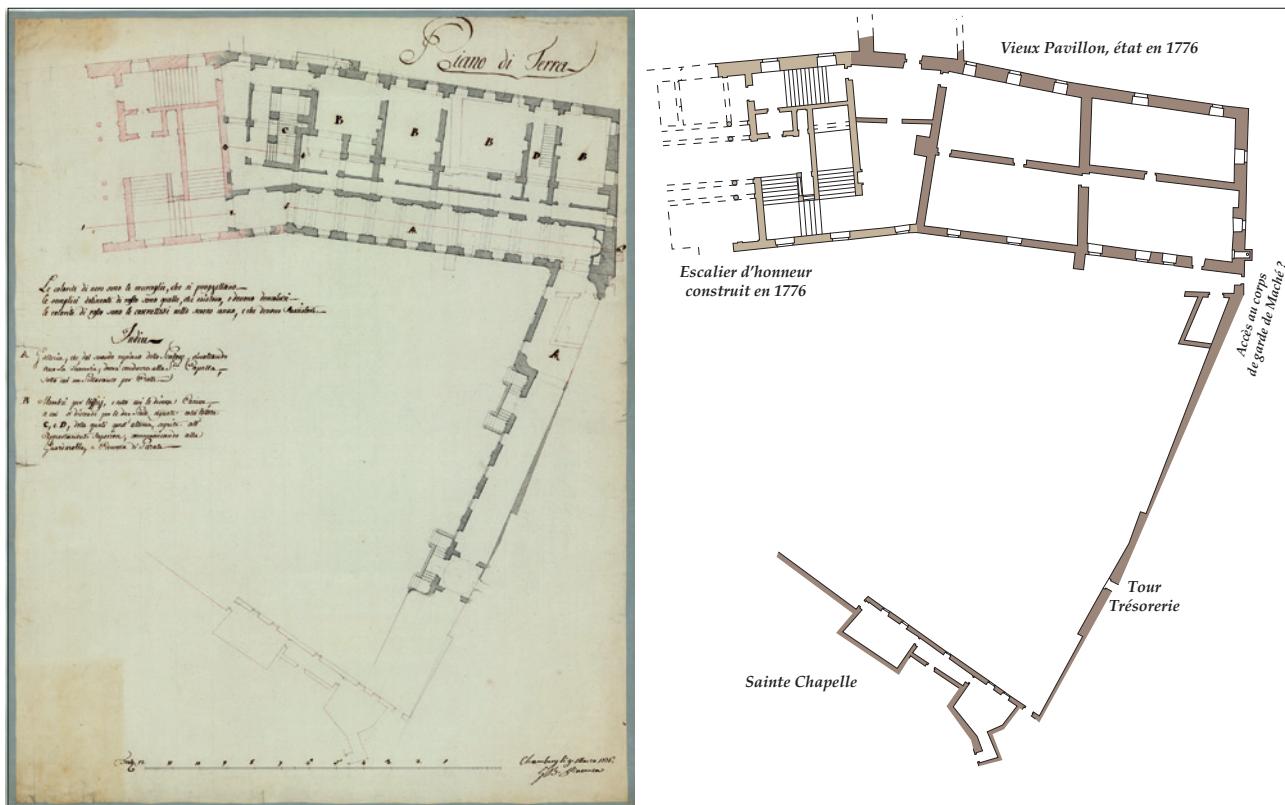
Plan restitué du Vieux Pavillon dans son état de 1775, d'après le projet d'aménagement. ASTo, Pallazi Reali, n. 014-002924 ; DAO : L. D'Agostino.
